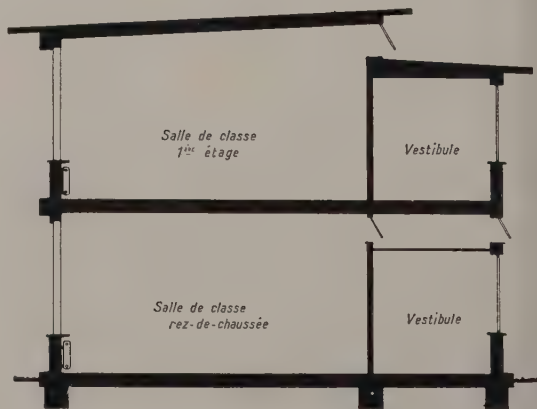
Ventilation transversale dans un bâtiment scolaire à étages.
